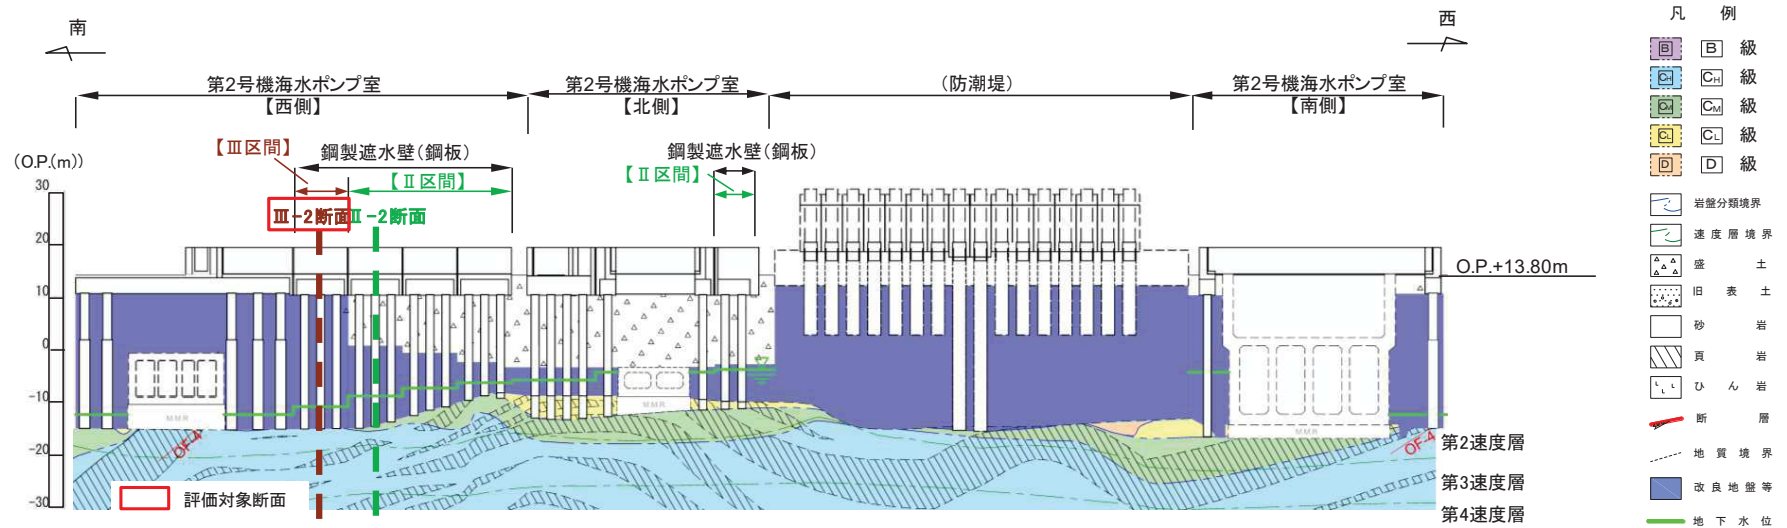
(1) 評価対象断面の地質縦断図 (第2号機海水ポンプ室)
